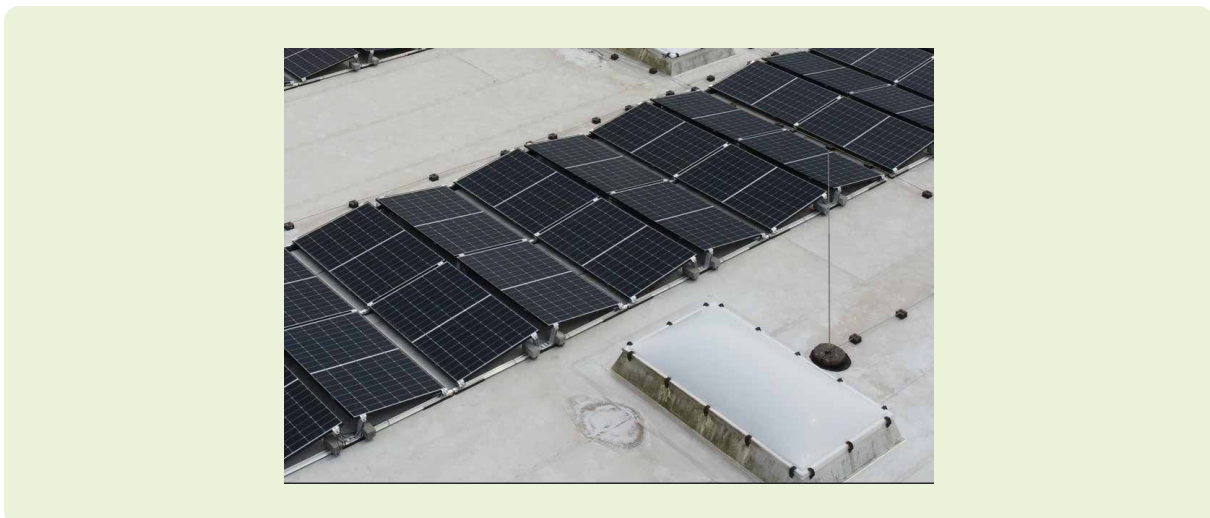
Detail: reduziert ballastierte Dachanlage neben Oberlicht und Blitzschutzfahne
